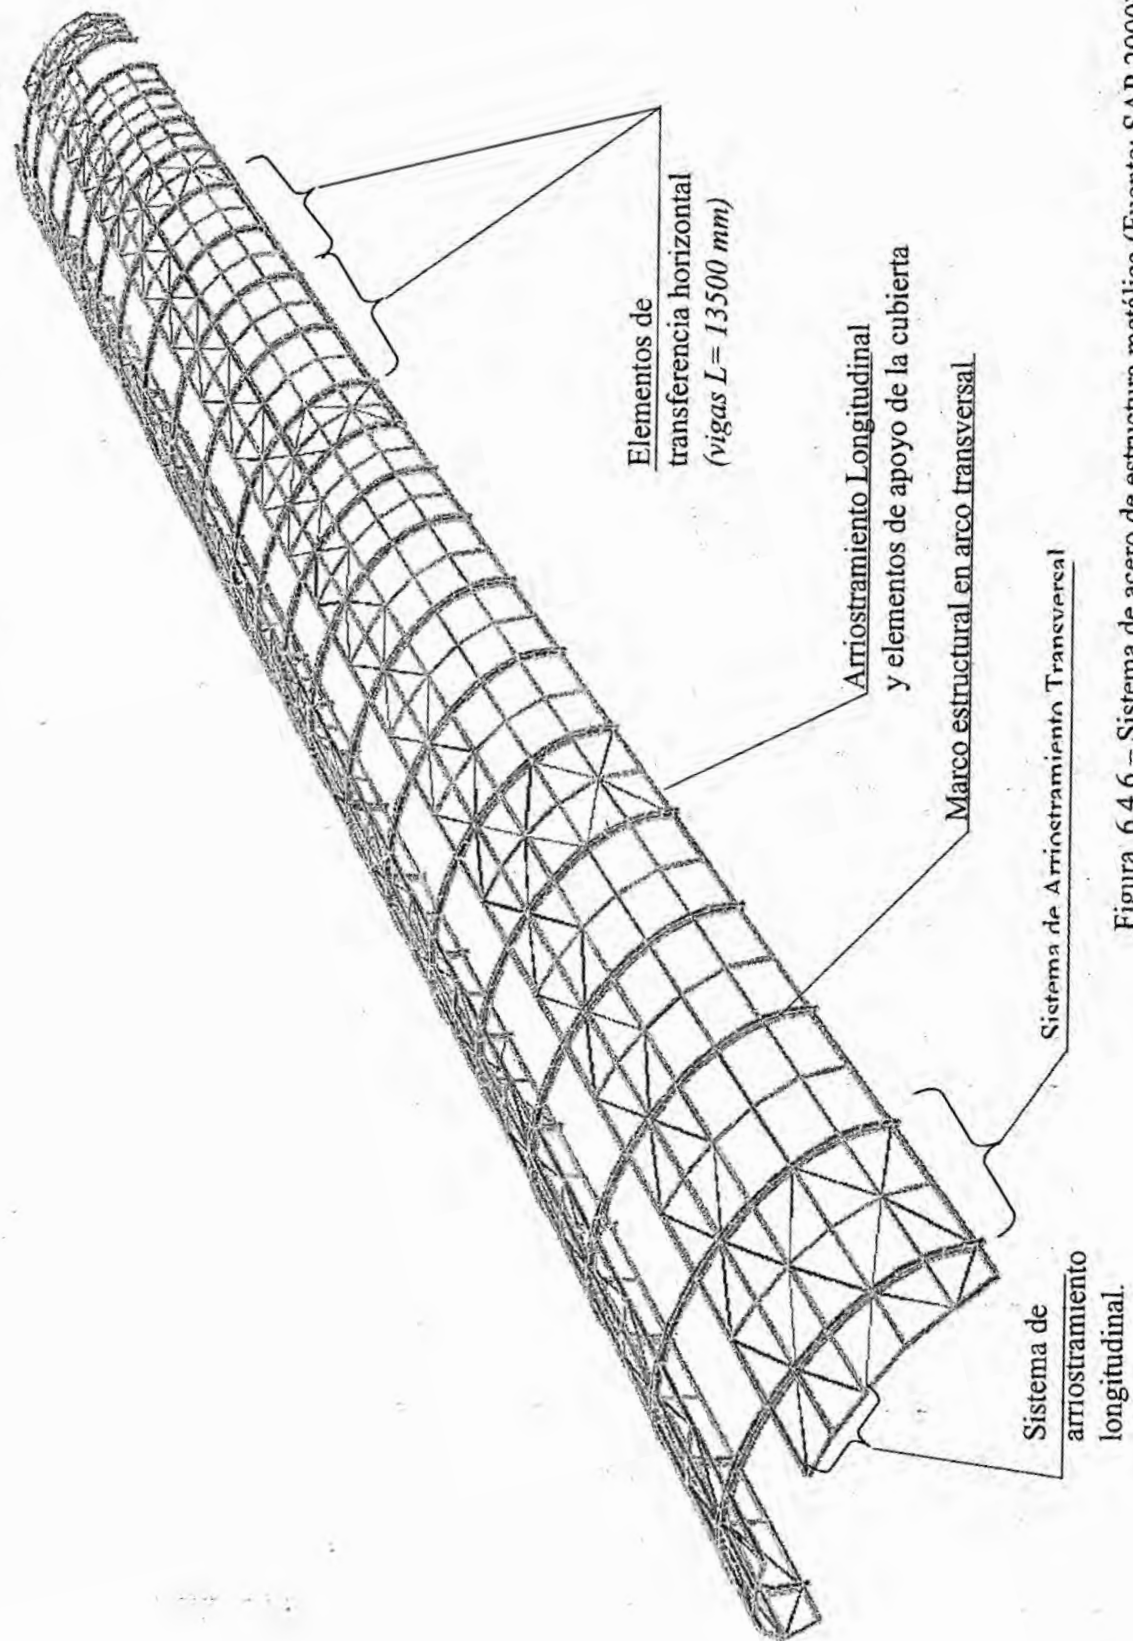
Sistema de acero de estructura metálica (Fuente: SAP 2000)
